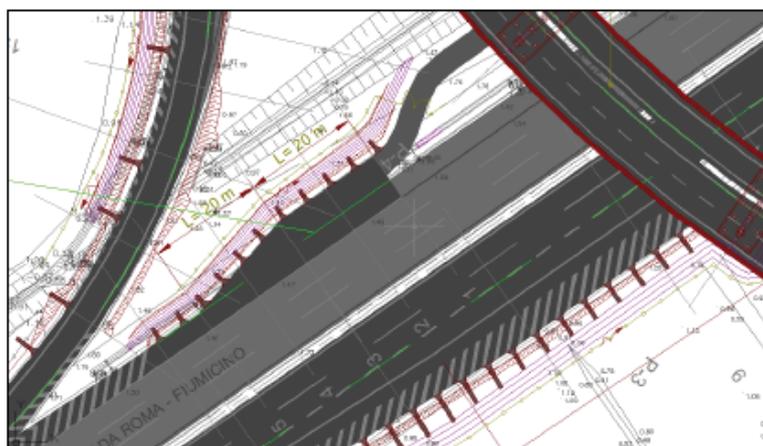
Planimetria di Progetto – Riprotezione accesso area manutenzione vasca su A91
